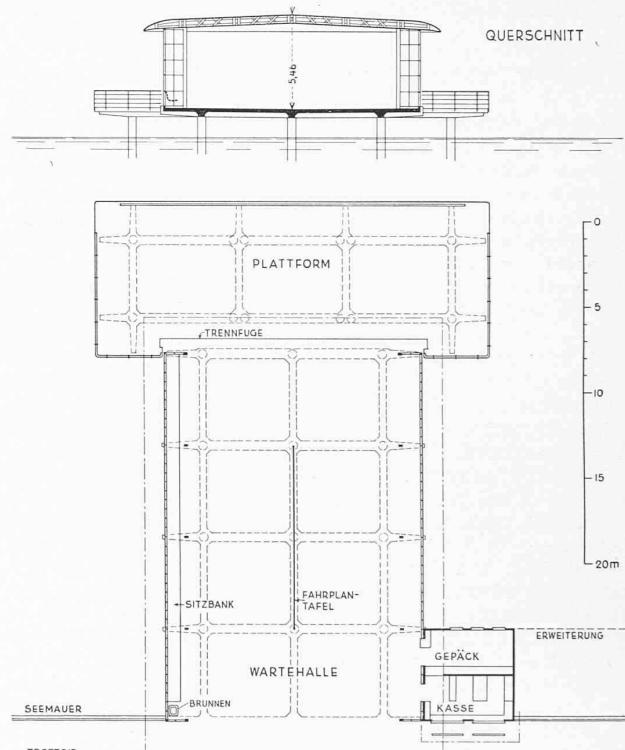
u. 4. Grundriss und Querschnitt. — Maßstab 1 : 400
